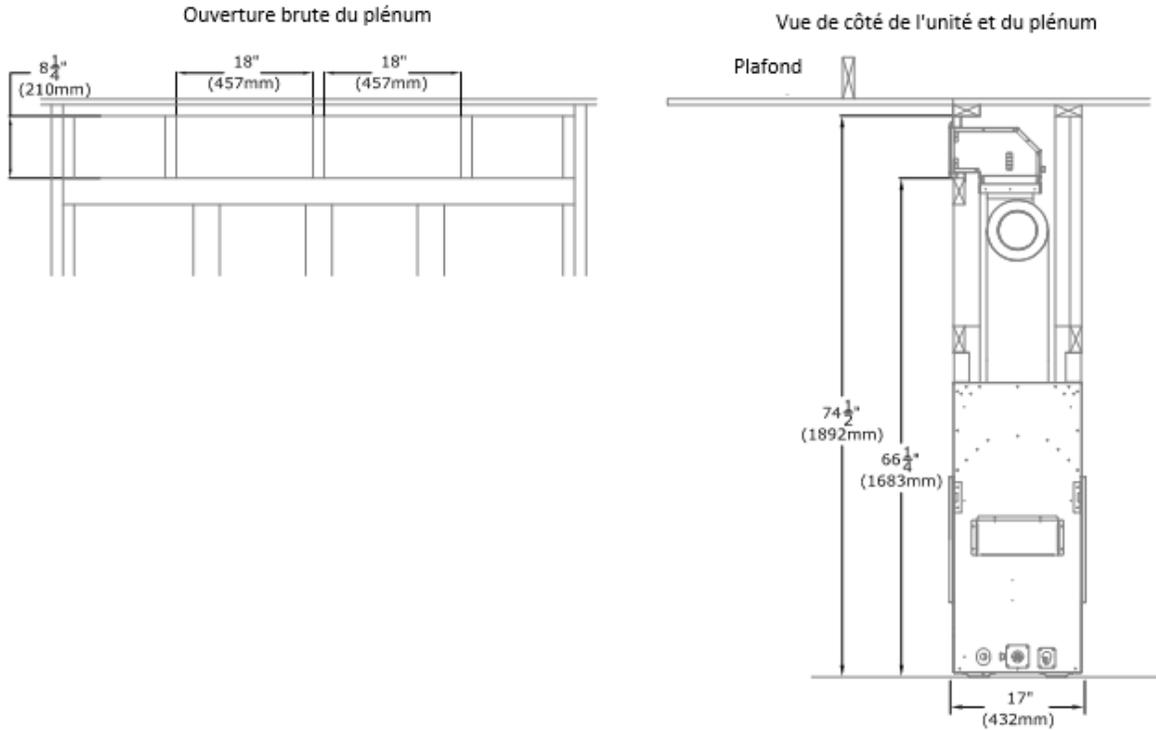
Dégagements et dimensions minimum d'encadrement de plénum pour le foyer Callaway See Thru
